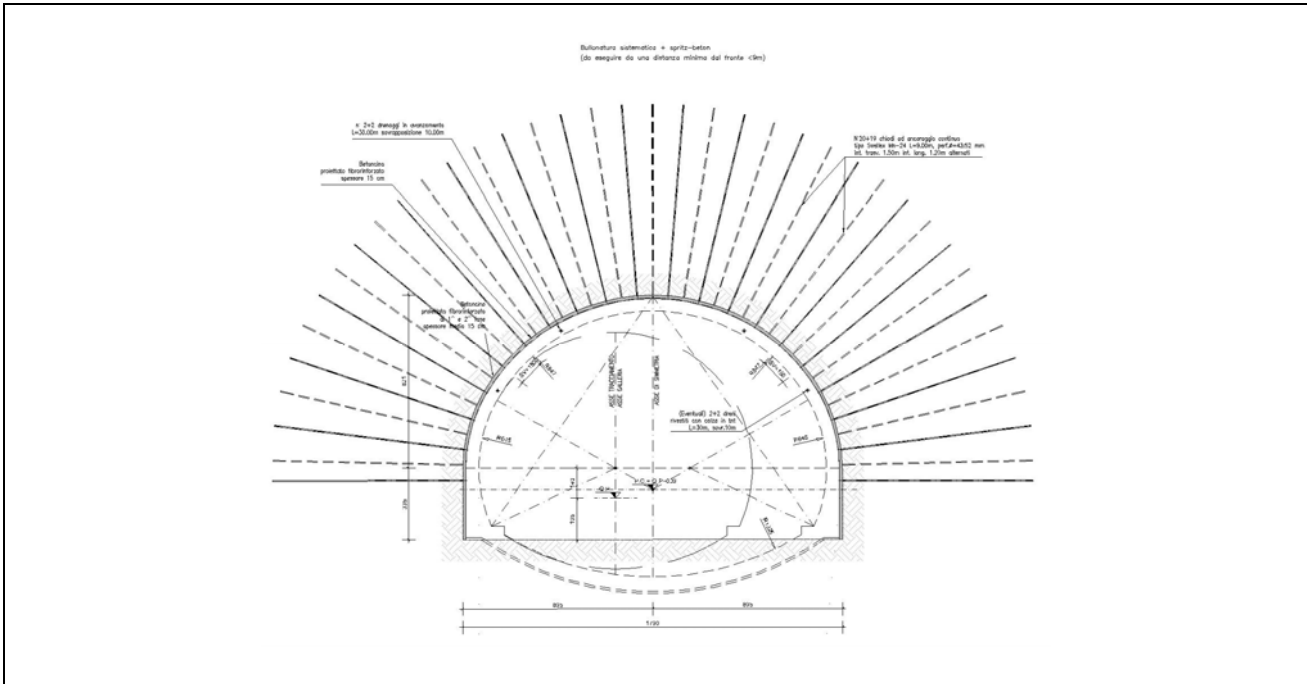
Sezione di scavo tipo GD-PS-A1 – PIAZZOLA DI SOSTA - Sezione trasversale
